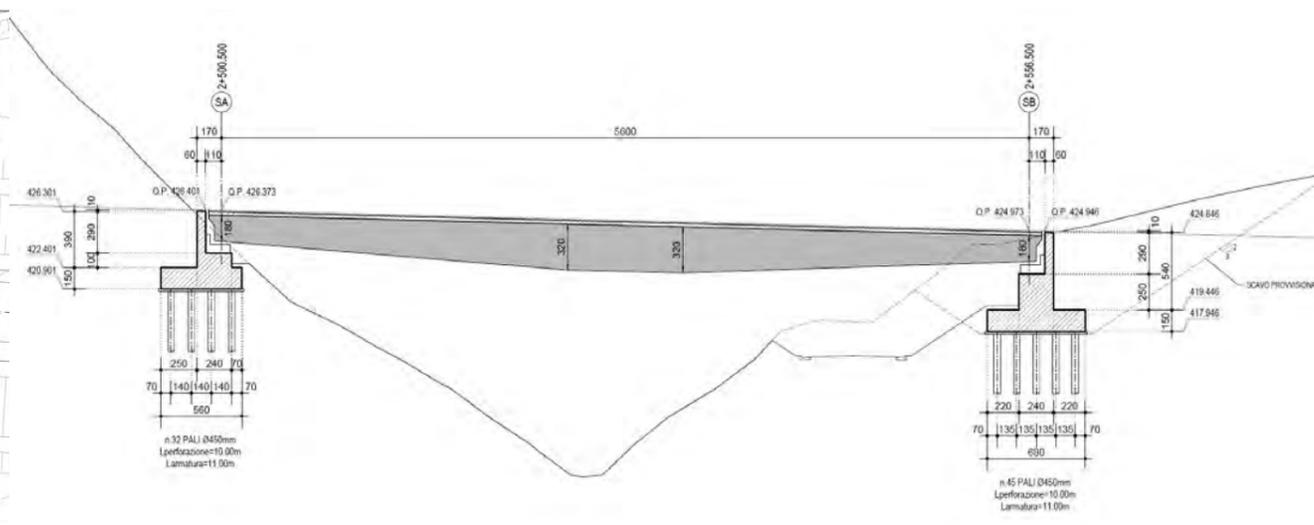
Sezione longitudinale lungo asse tracciamento
